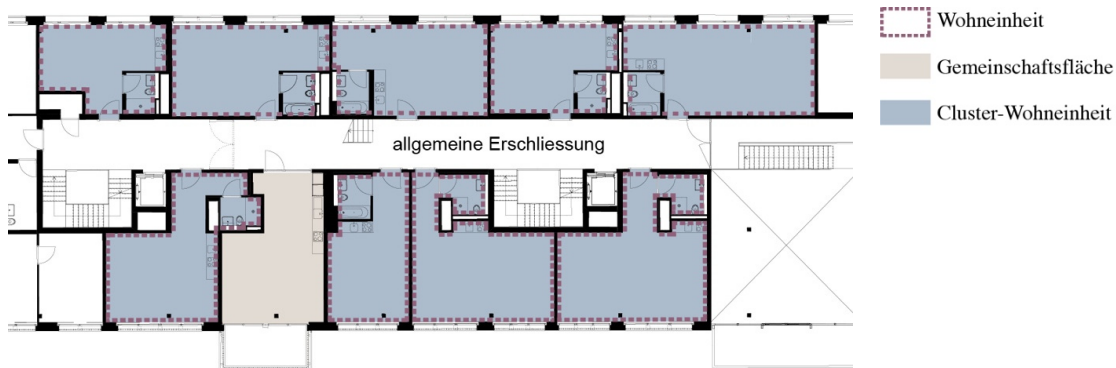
Grundriss offene Clusterwohnung, Beispiel Überbauung Kalkbreite (Müller Sigrüst Architekten; eigene Darstellung)
